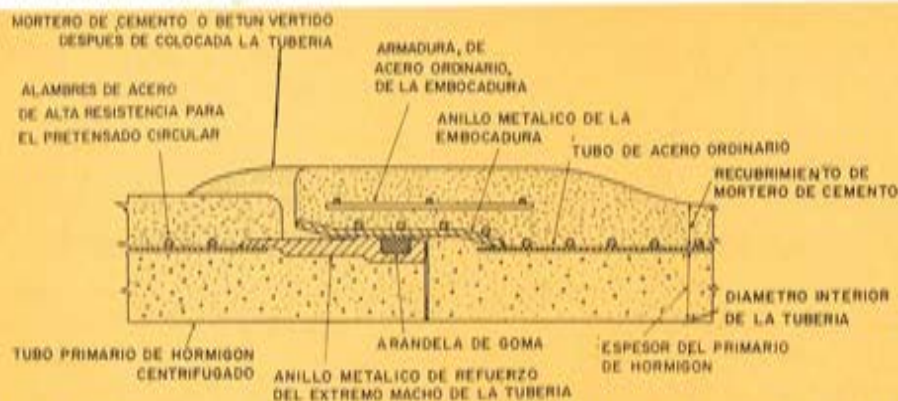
Sección-tipo de una tubería cilíndrica, de hormigón pretensado, con camisa exterior de chapa.
